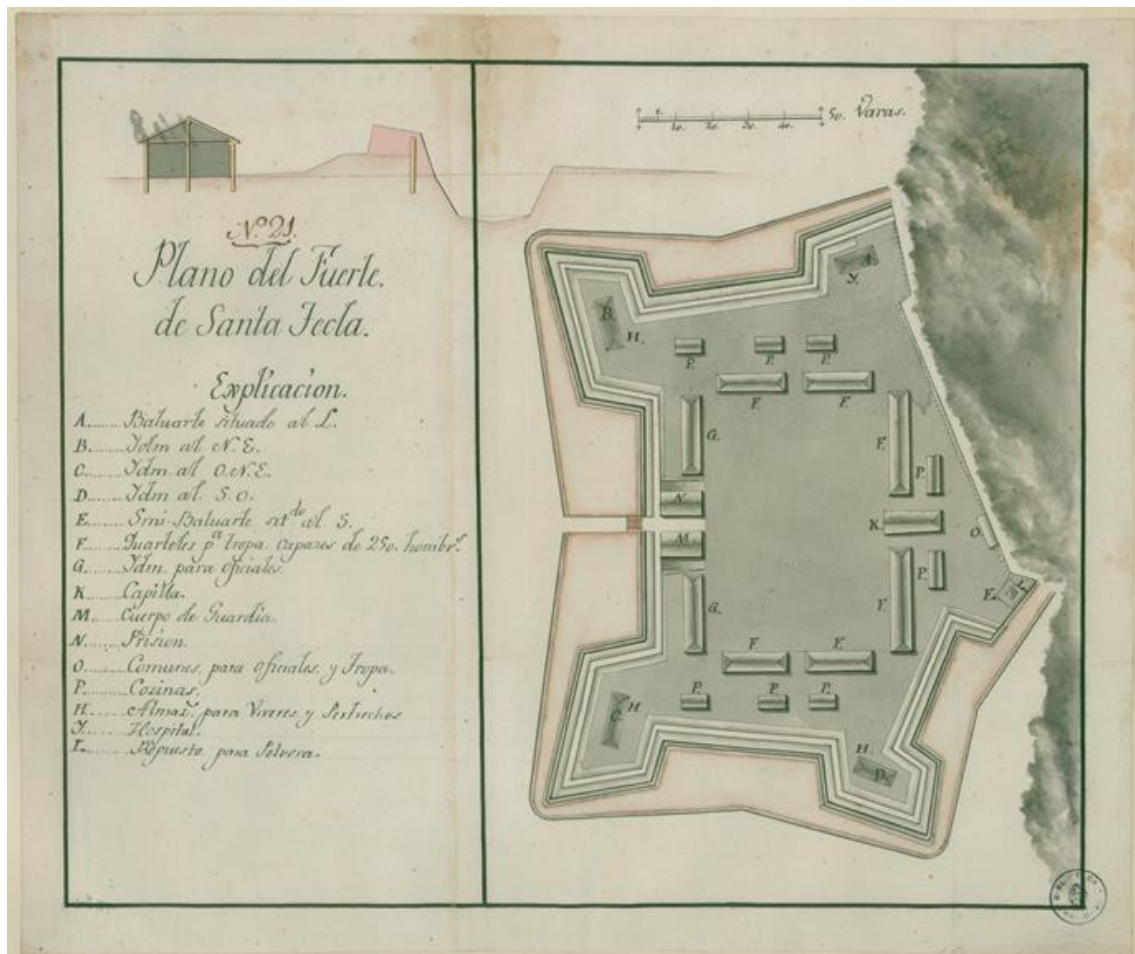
Plano fuerte Santa Tecla. Fuente: <http://www.visitgenoa.it/es/fuerte-santa-tecla>.
